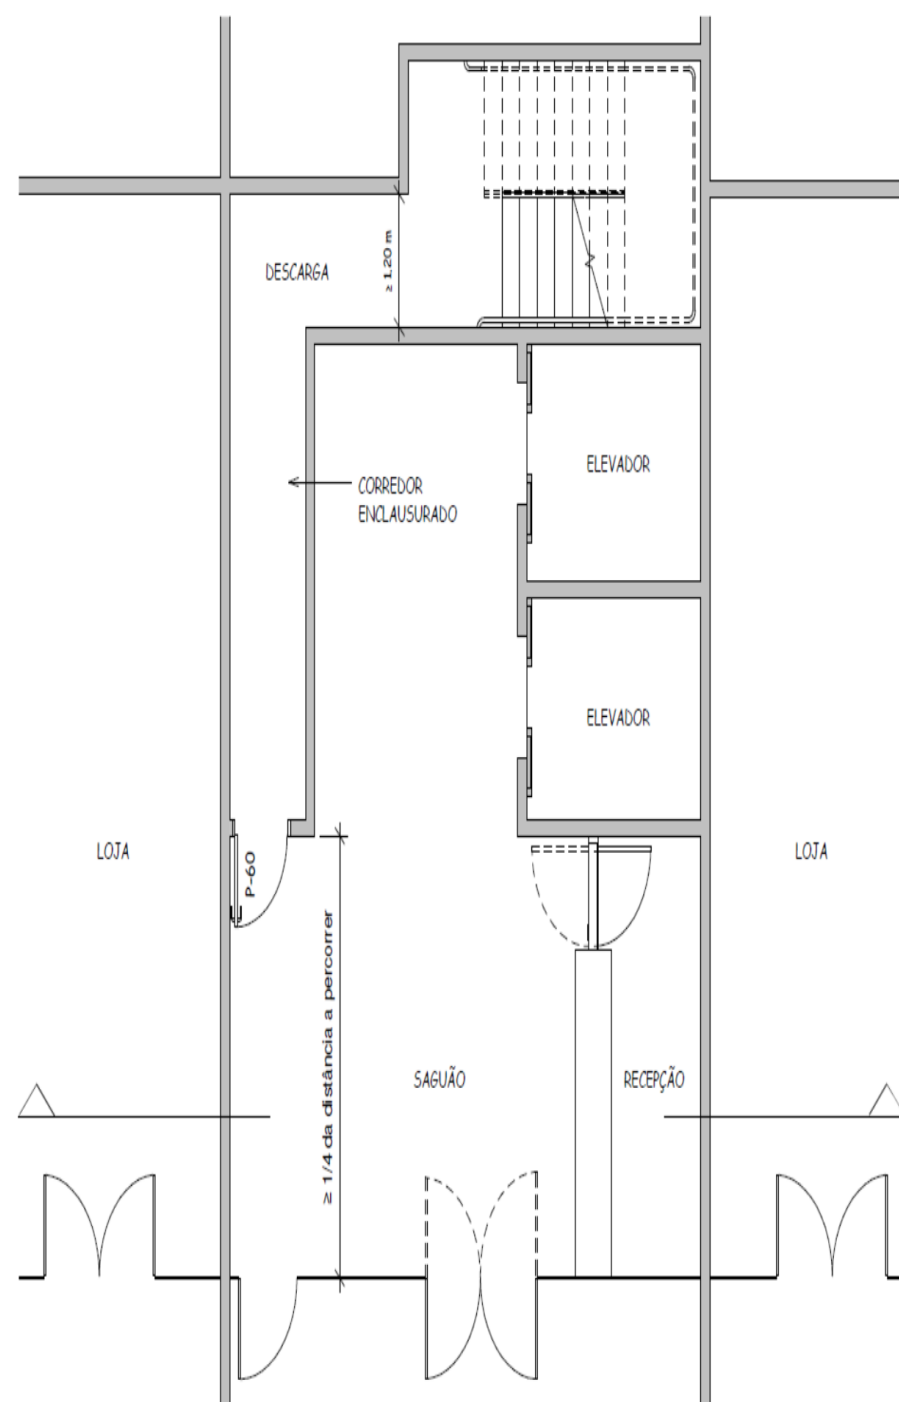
D - Descarga com corredor enclausurado (planta baixa).
